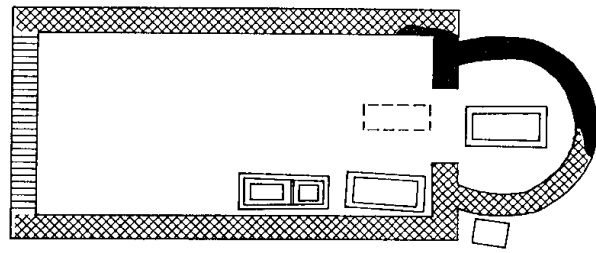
Burgfelden, Sankt Michael. Grundriss von Bau I (um 700) mit Gräbern. Umzeichnung nach Grosse Baudenkmäler, Heft 177 (München 1981).
